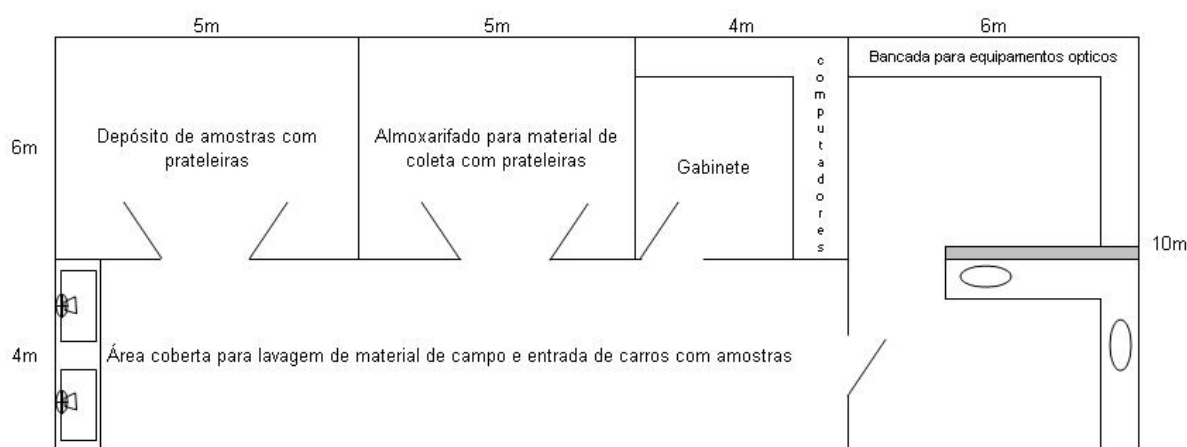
Layout do laboratório de ictiologia a ser construído na UFPA/campus Belém
